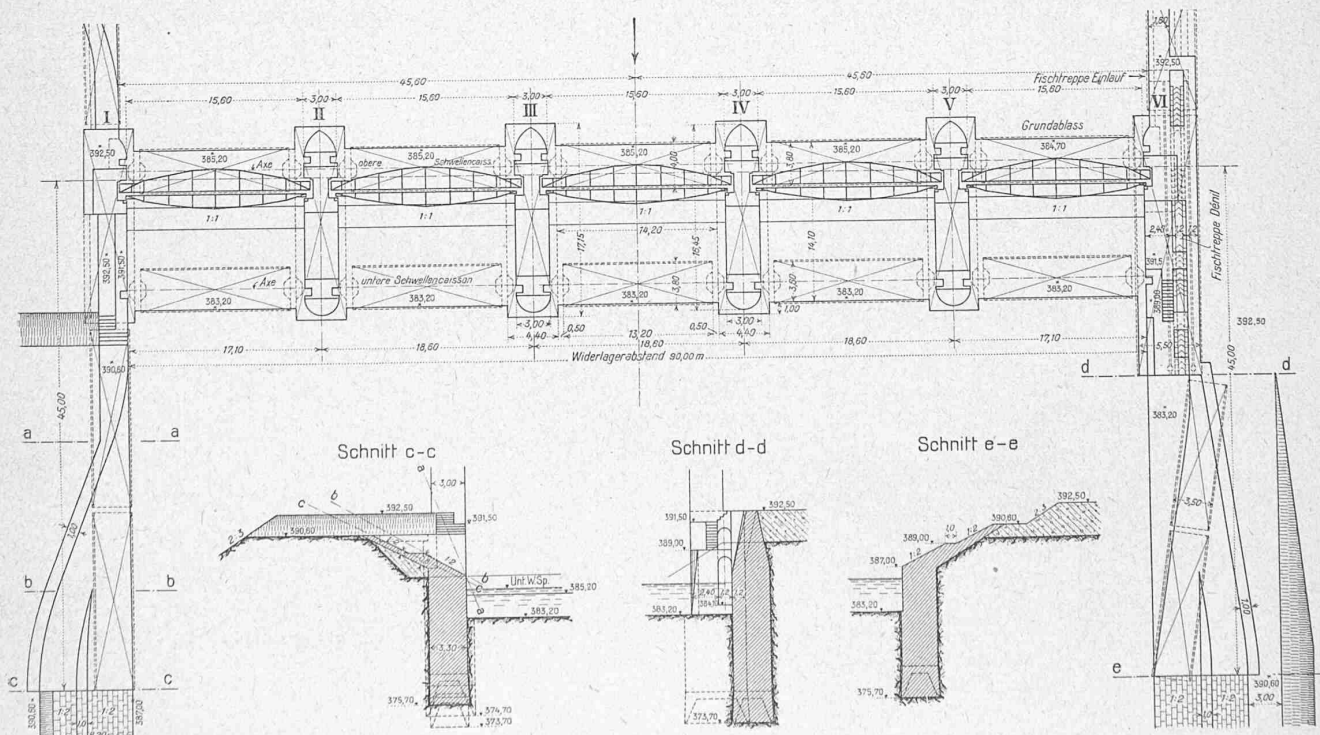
Grundriss des Stauwehres und Schnitte der Unterwasser-Flügelmauern. — Masstab 1:600.
